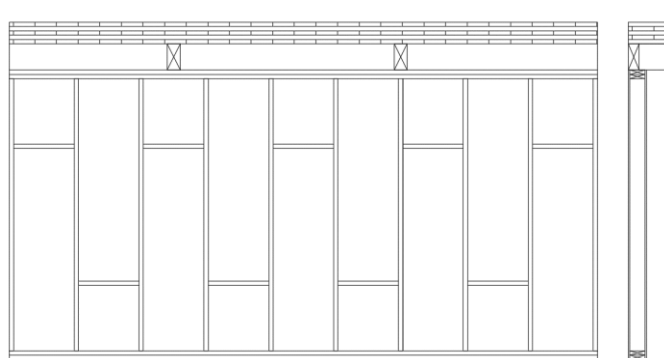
CLT apoiado sobre vigas de pavimento que descarregam sobre a parede em *timber-frame
